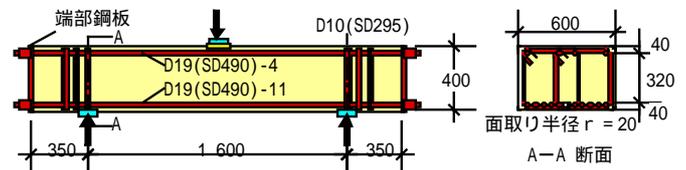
せん断実験用はり試験体 形状・寸法・配筋図
